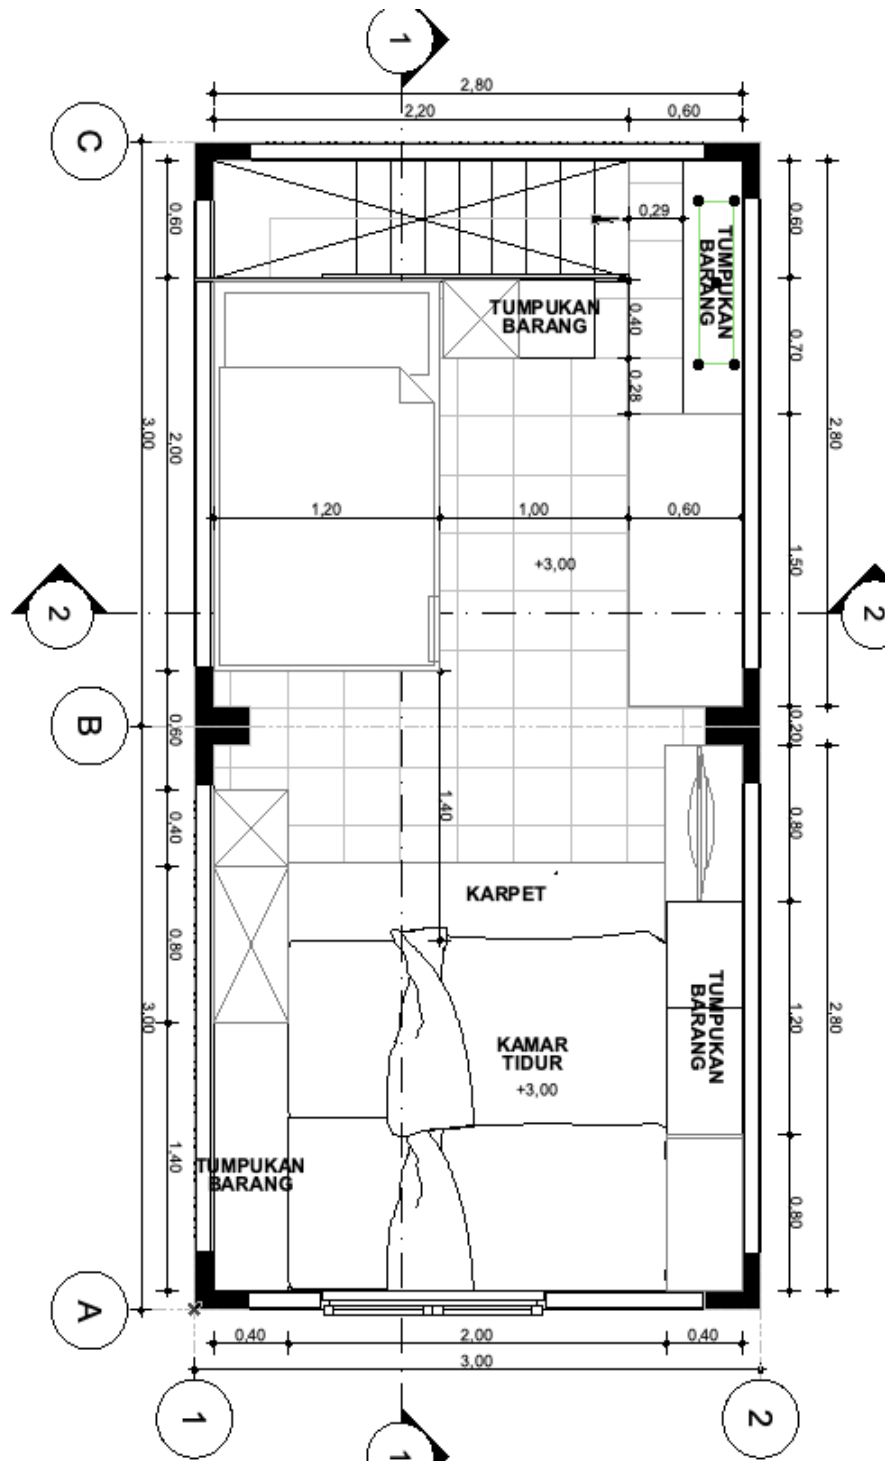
Layout Denah Lantai Dua Tipe 18
